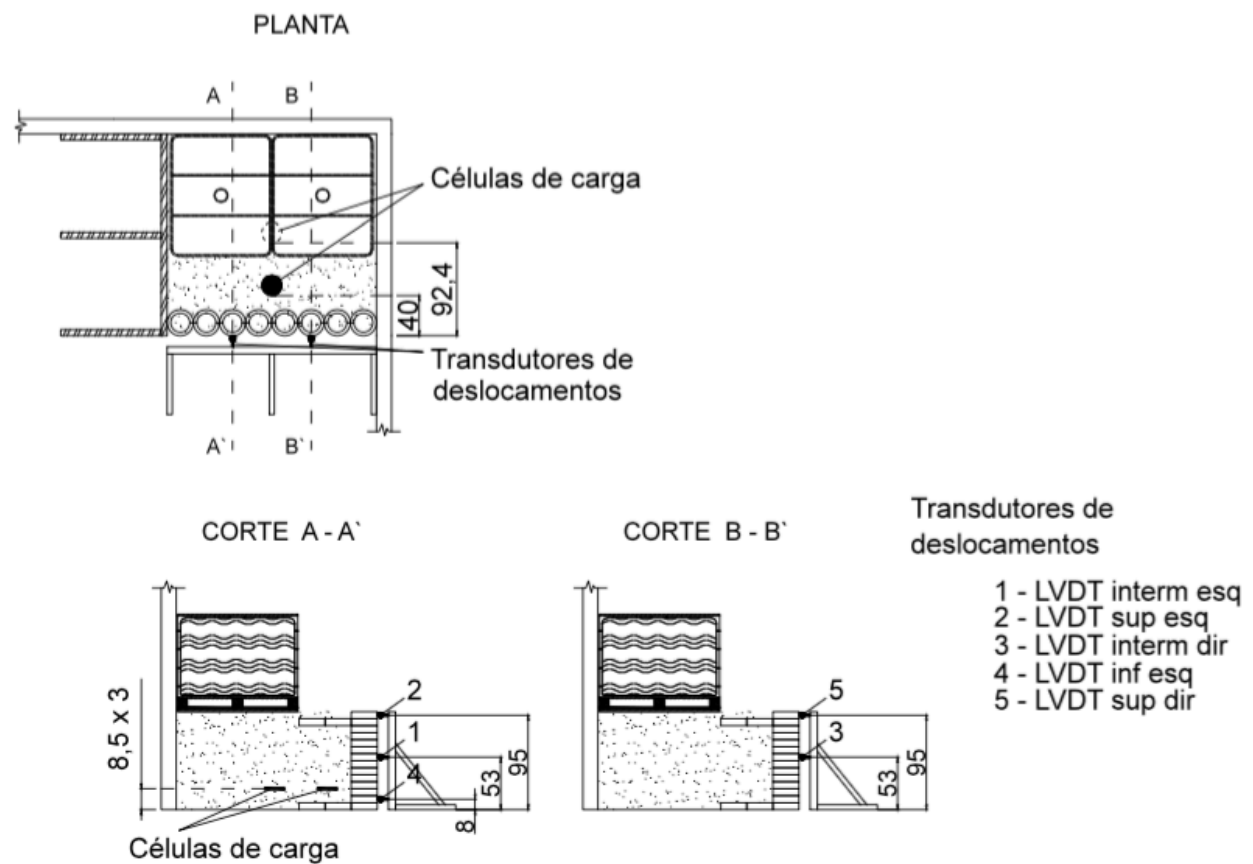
Esquema em planta e em corte da instrumentação instalada no modelo inicial.
